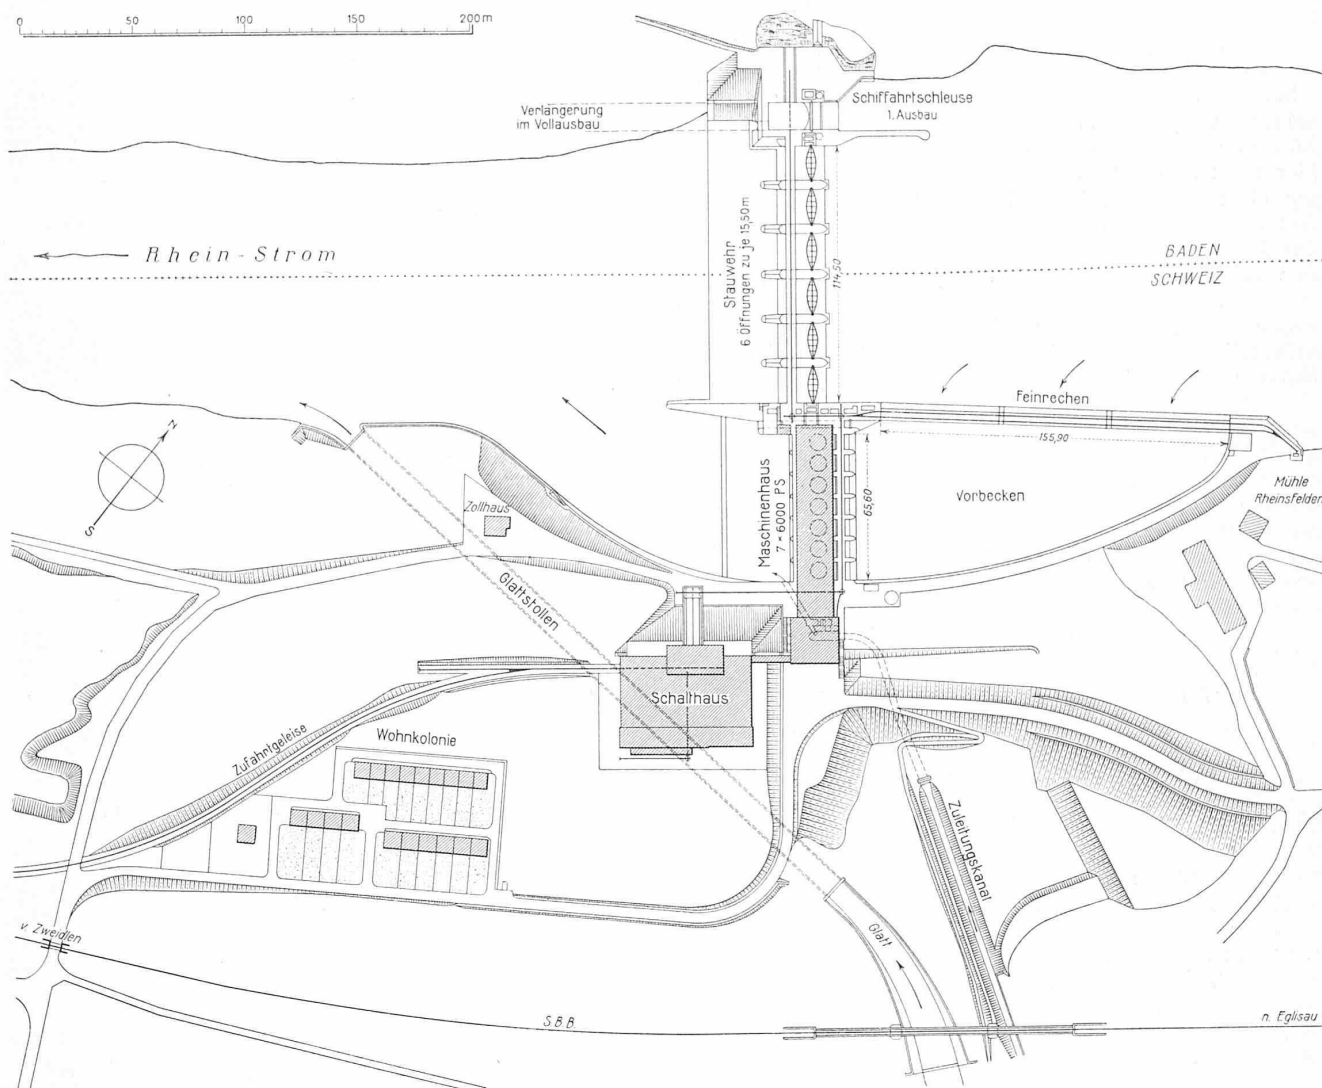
Lageplan des Rheinkraftwerks Eglisau. — Masstab 1 : 3000.
